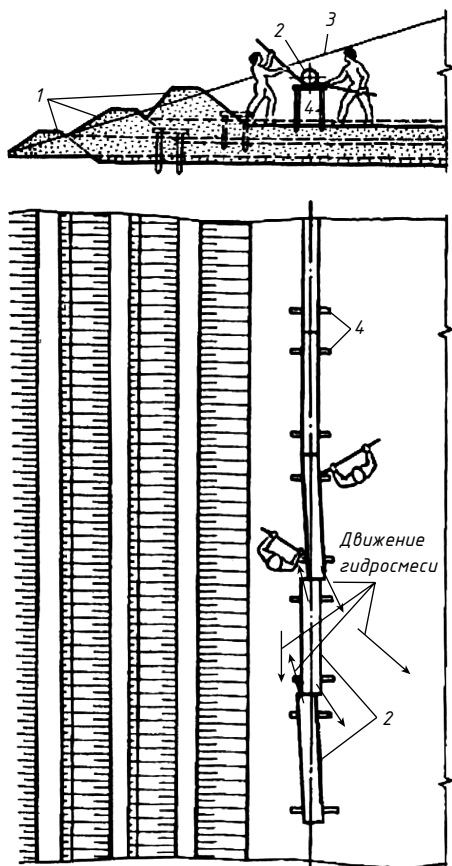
Схема организации работ при низкоопорном способе намыва с рассредоточенным выпуском гидросмеси:
